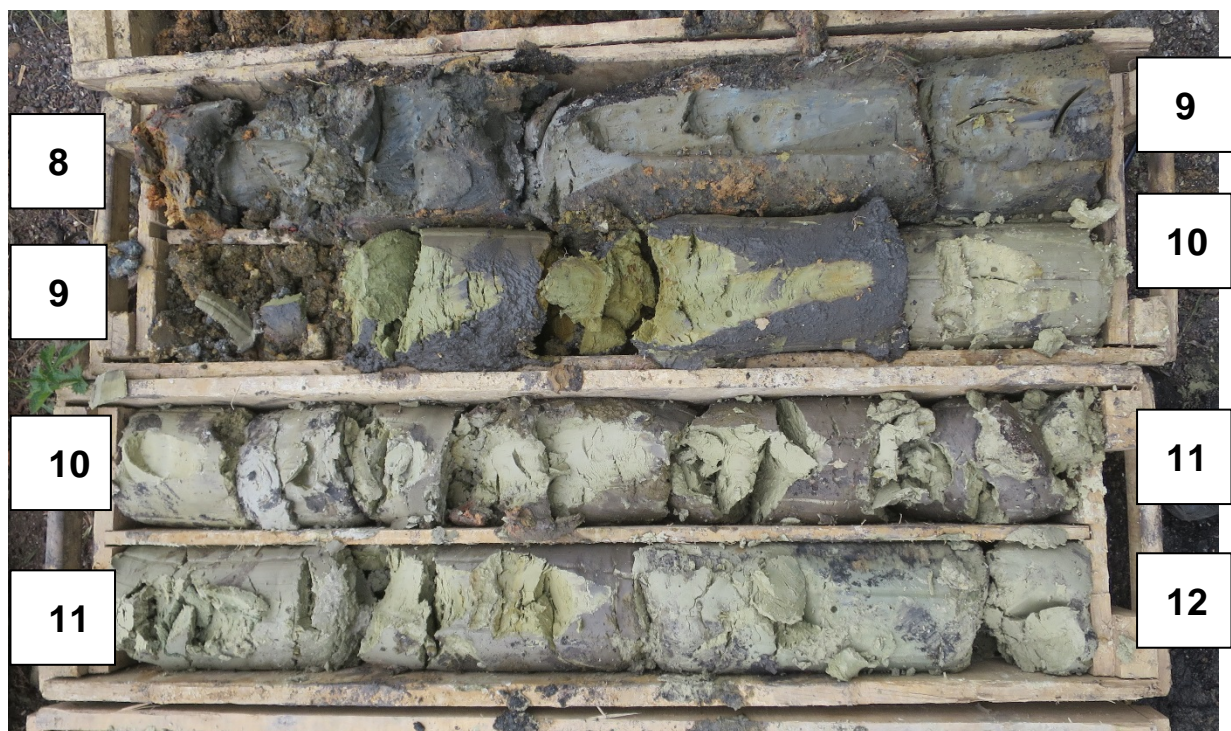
VRT J8 (8,0 – 12,0 m)
